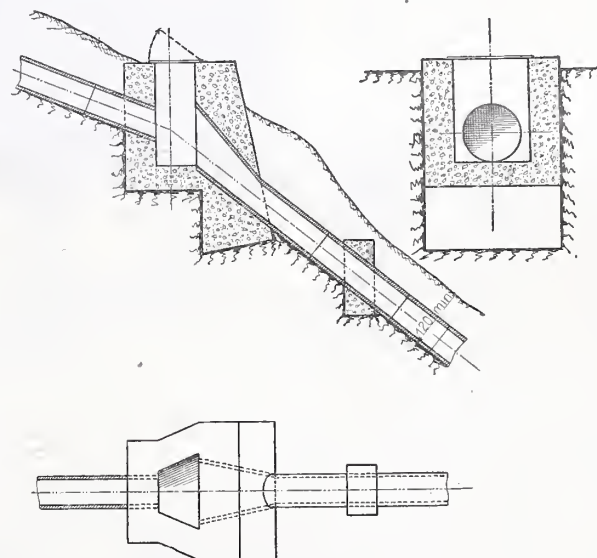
11. Grundriss und Schnitte der Ueberfall-Leitung mit Betonmassiv. 1:150.
